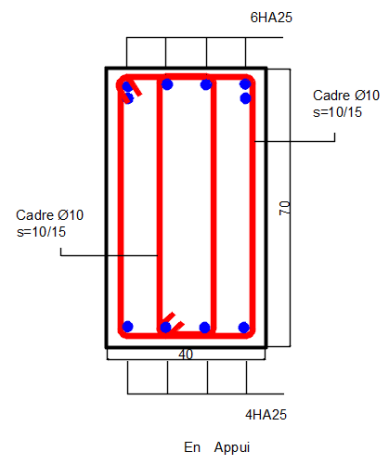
Ferrailage des poutres 70× 40 (En appui).
